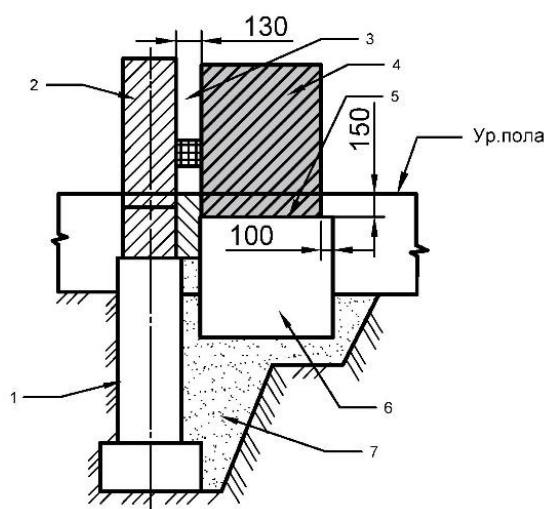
Конструкция фундамента печи, расположенной у наружной стены, с большой глубиной заложения: 1, 6 – фундаменты, 2 – стена, 3 – отступка, 4 - массив печи, 5 – гидроизоляция, 7 – песчаная подушка.
